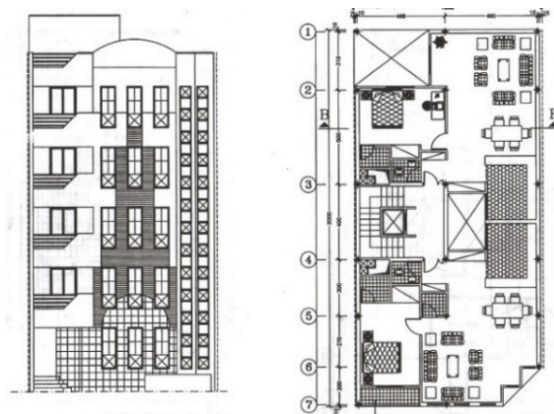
Фасад и план этажа жилого дома с двумя квартирами на этаже (Тегеран)
